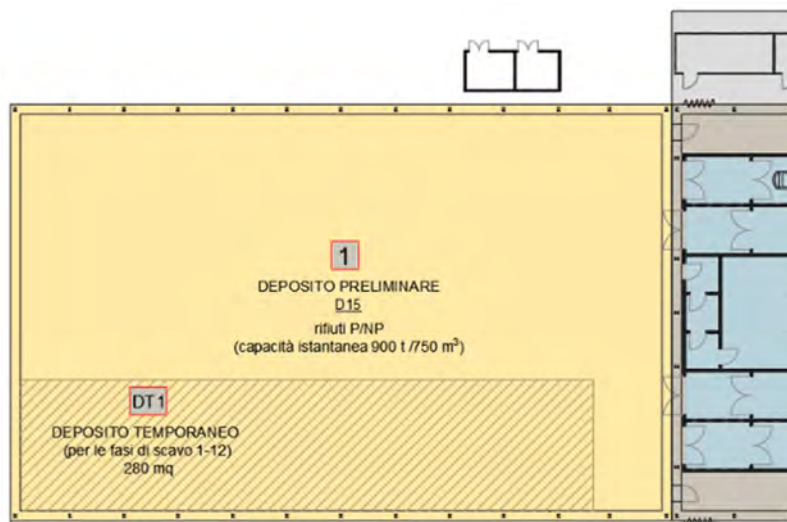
Stralcio fabbricato Deposito Preliminare D15, con individuata la zona del Deposito Temporaneo DT1.
